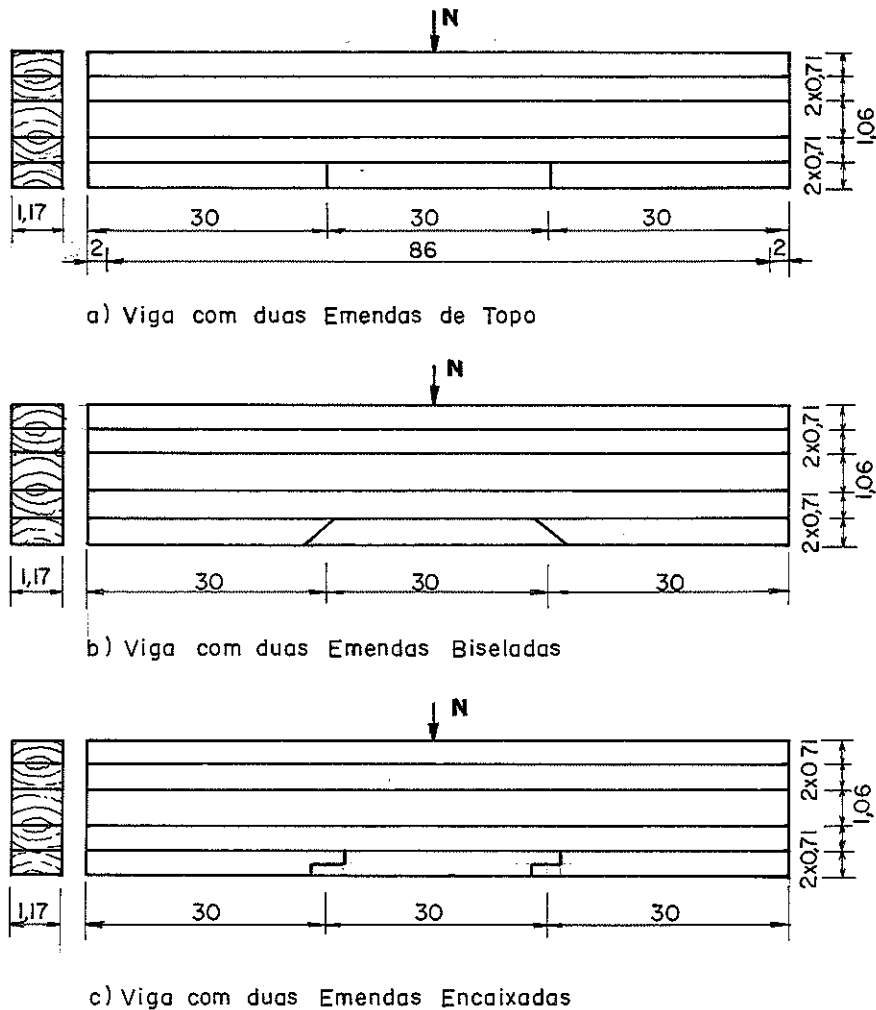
Vigas com duas emendas de topo, biseladas e encaixada
